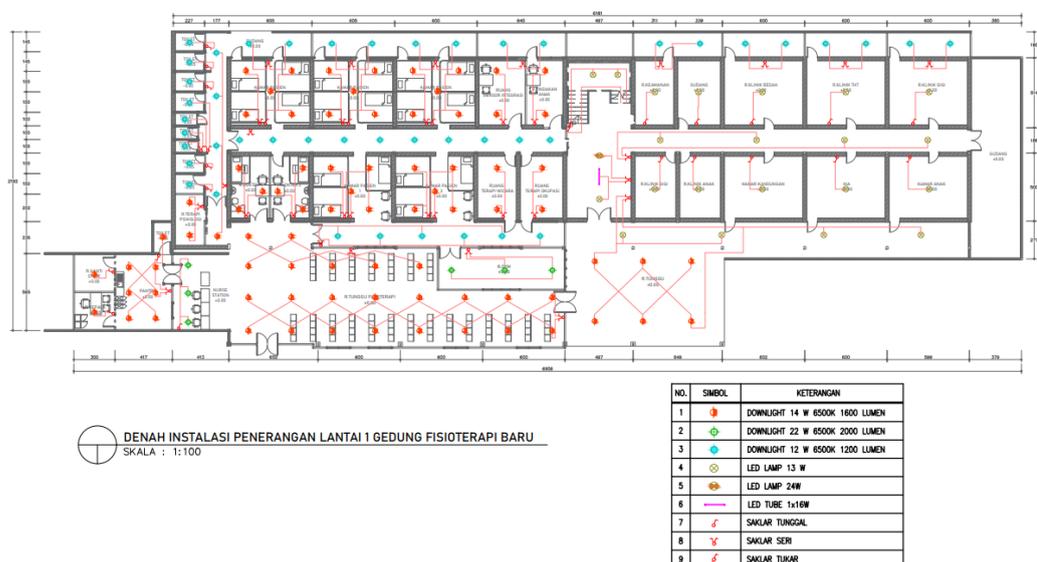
1 Denah Gedung Fisioterapi Lantai 1
